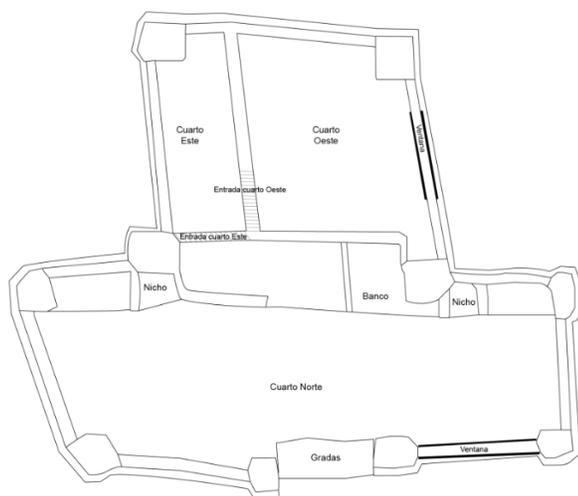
Vista de planta de la estructura 12, y su división interna.
